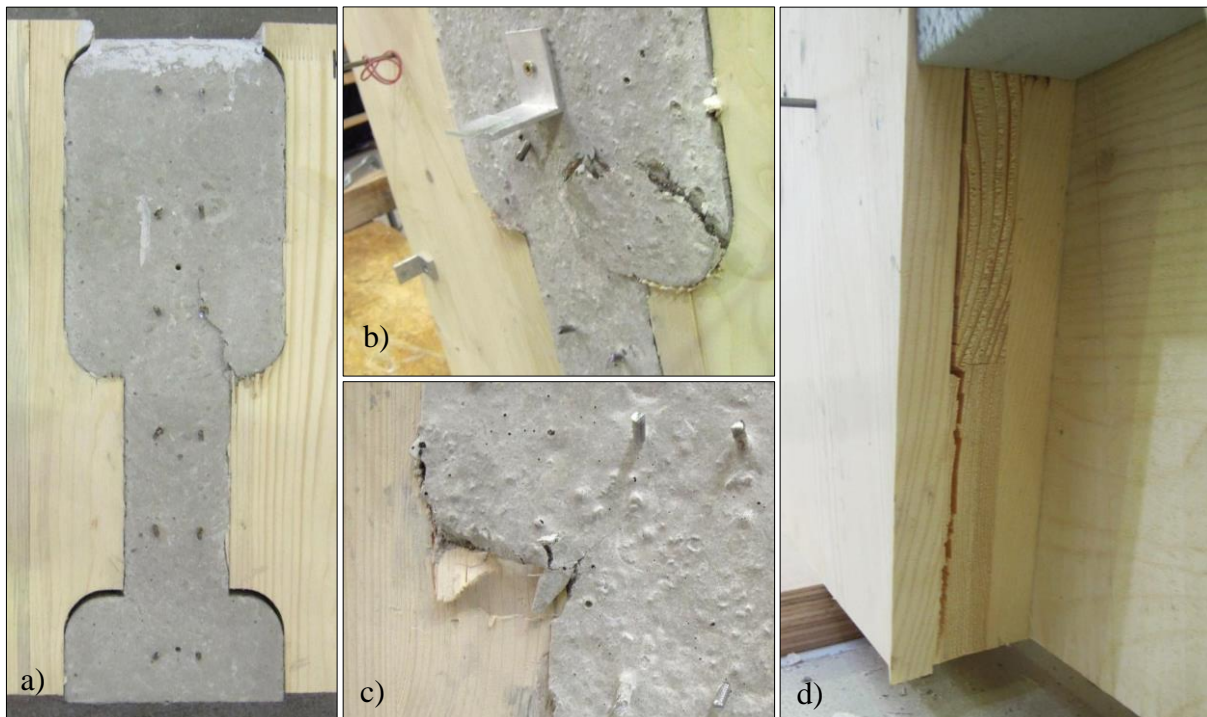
Bruchbilder: a) Betonrisse bei Abrundungen und Stirnholzpressung, b) Druckversagen bei Abrundungen und c) lokales Abscheren der Außenlage im BSP
